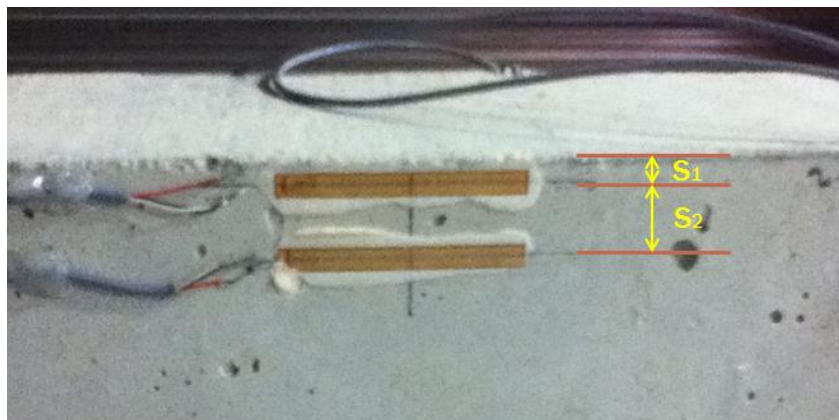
Emplacement des jauges sur le béton pour mesurer sa déformation
